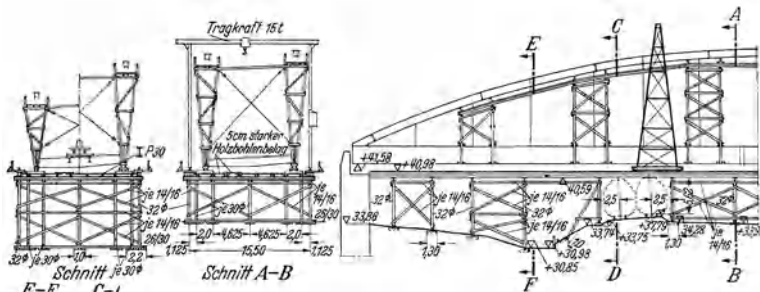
Aufstellgerüst der Reichsautobahnbrücke am Block Kaiserberg bei Duisburg.
